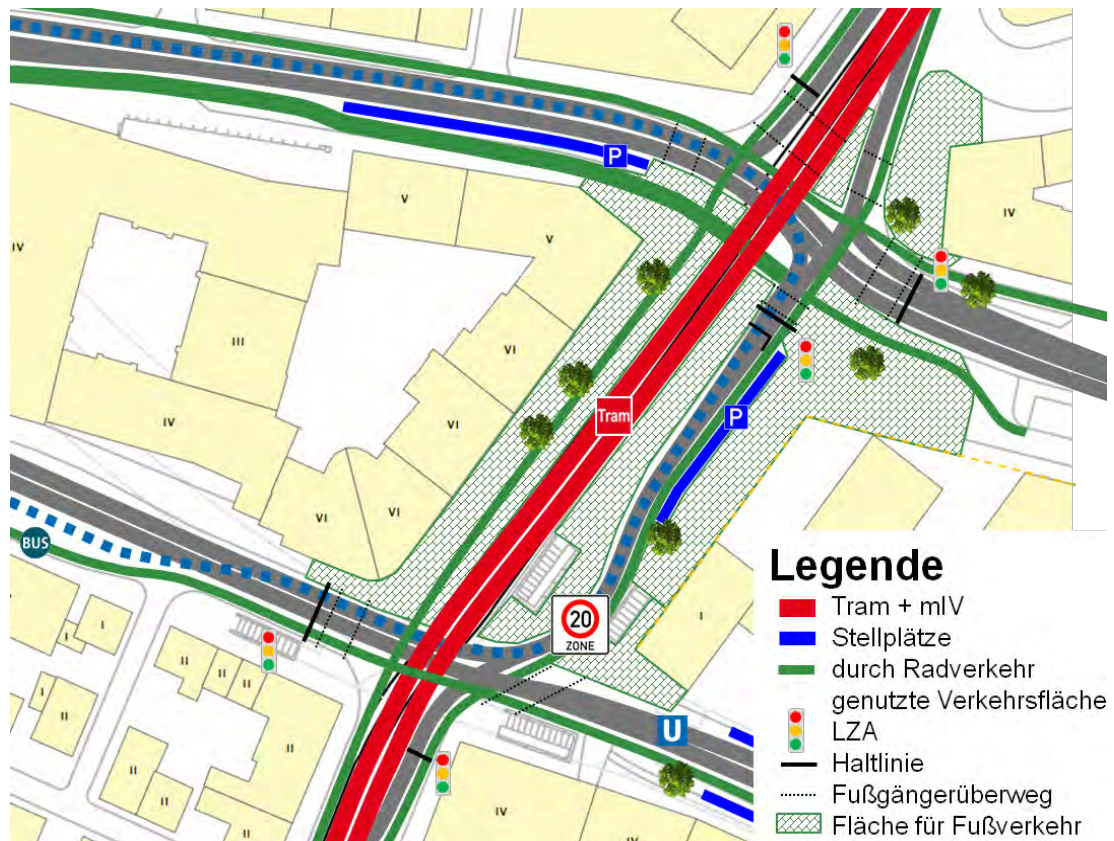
Lageplan des Tegernseer Platzes (Variante 2)
